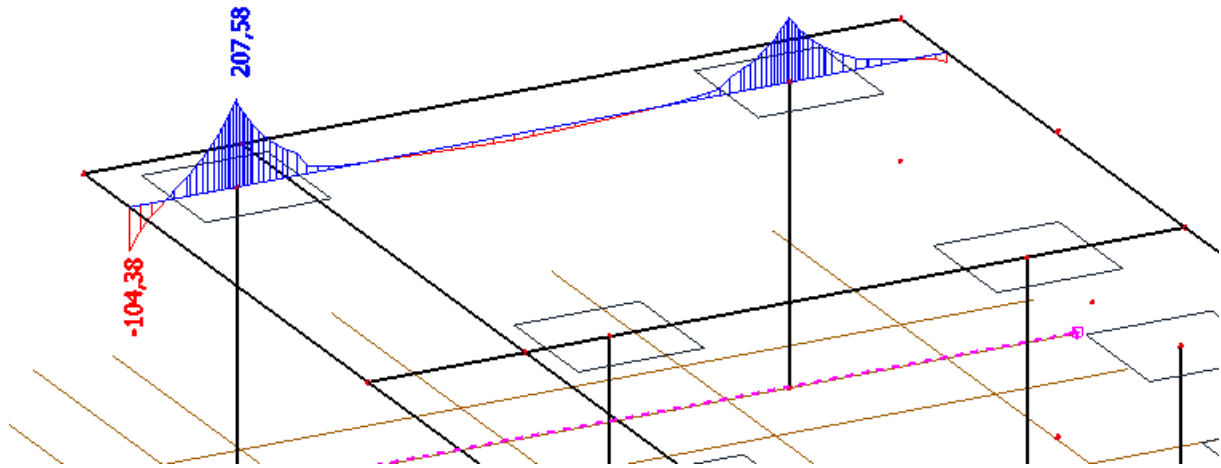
Průhyb v kritickém průřezu konstrukce
